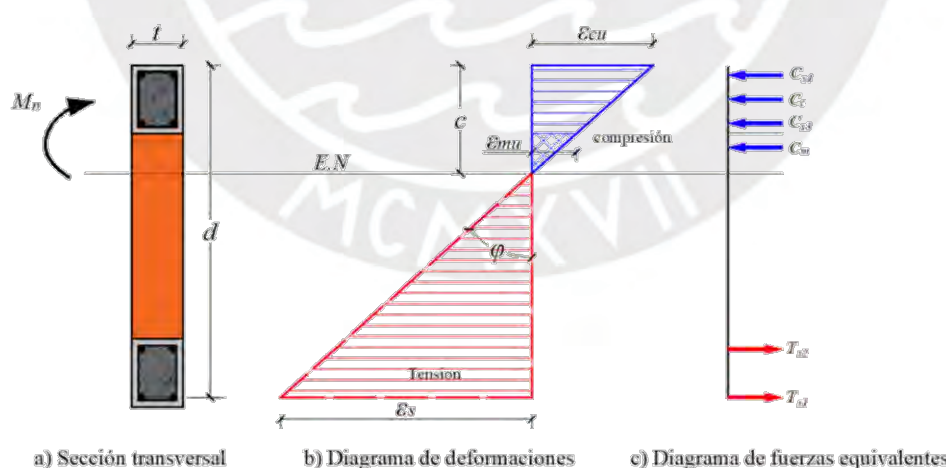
Análisis de sección transversal del muro de mampostería confinada [37].
